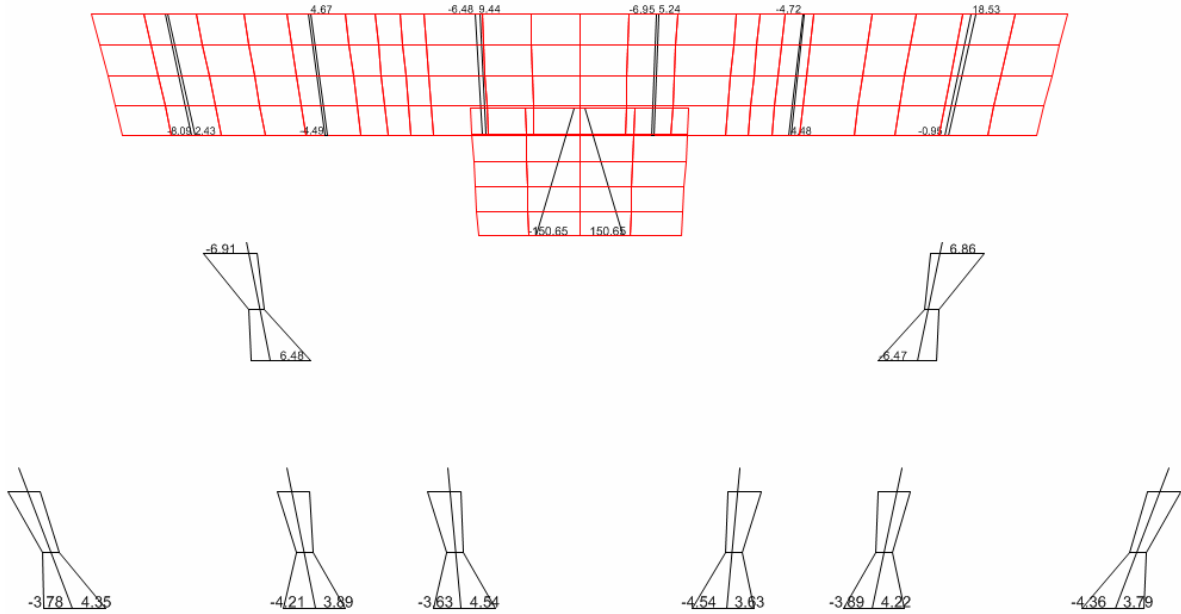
Se muestran los momentos en la planta baja. Se nota la gran cantidad de momento que toman los muros de concreto
